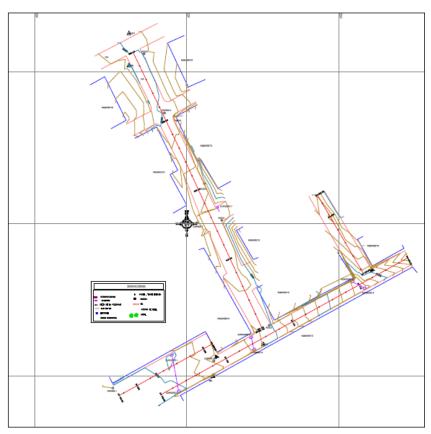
Vista en planta vías del barrio San Juan Bosco.
